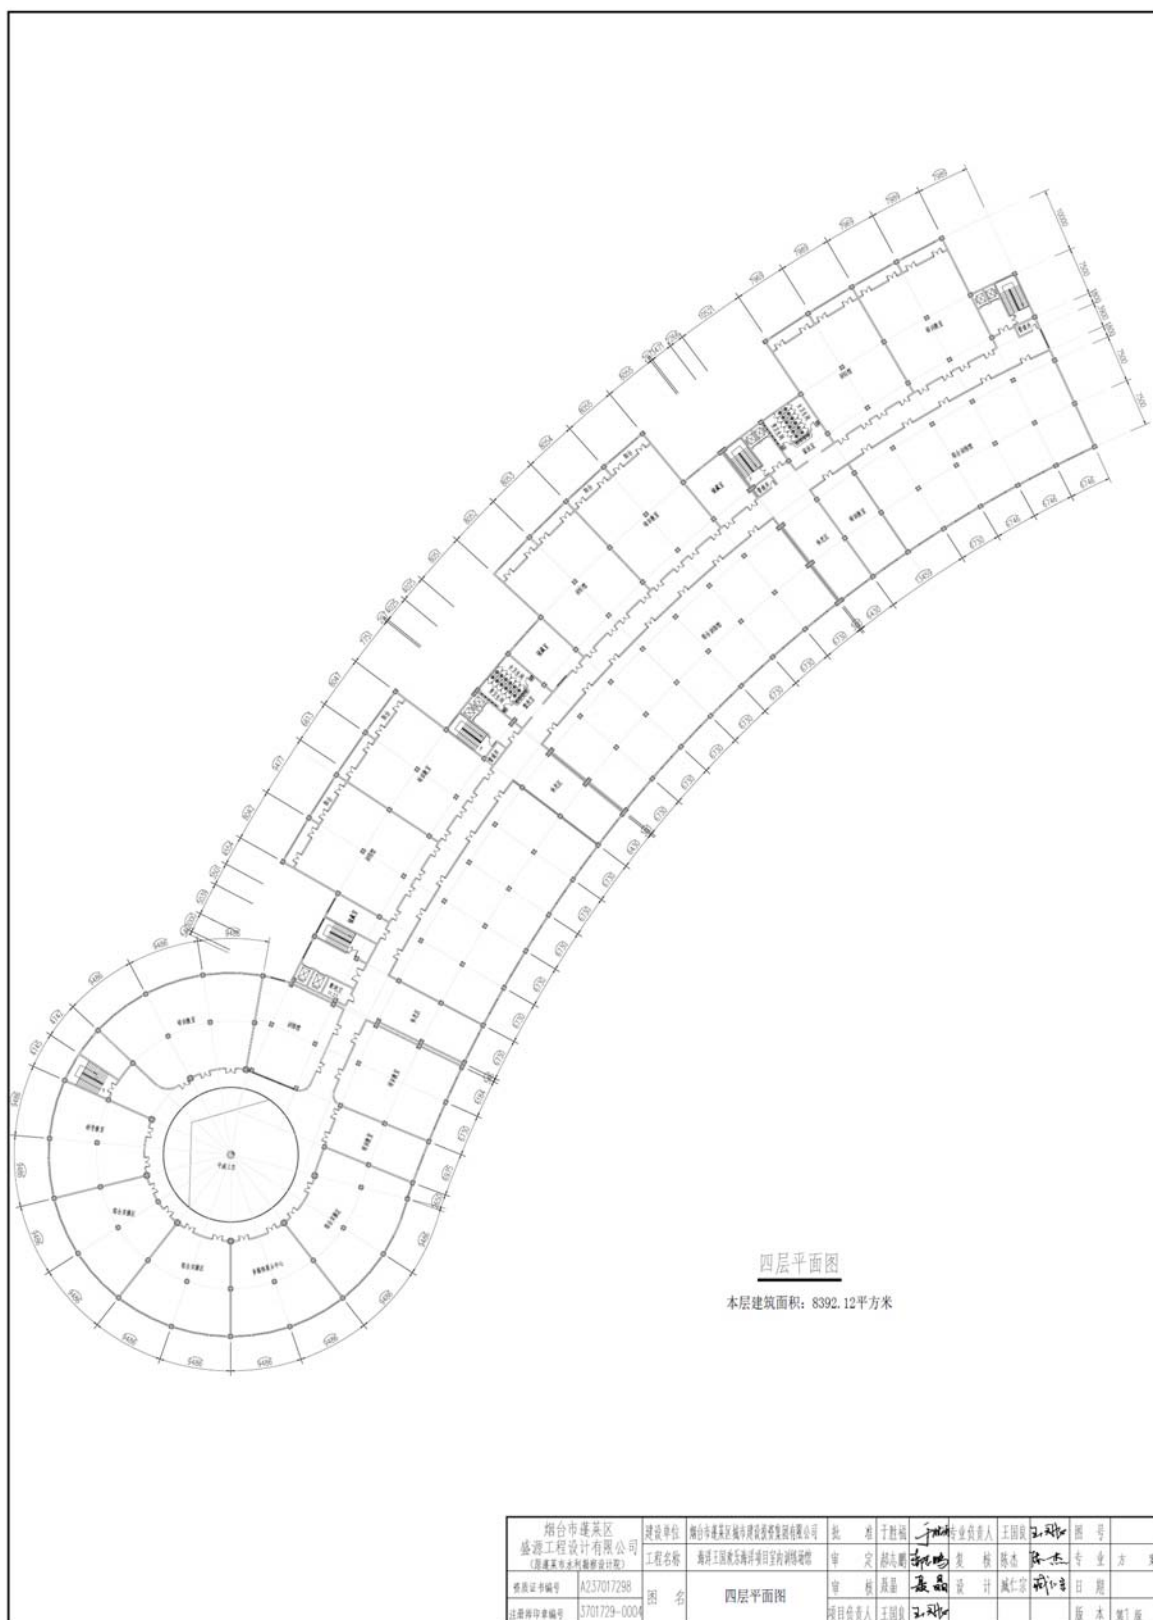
室内训练场馆平面布置图（四层）
